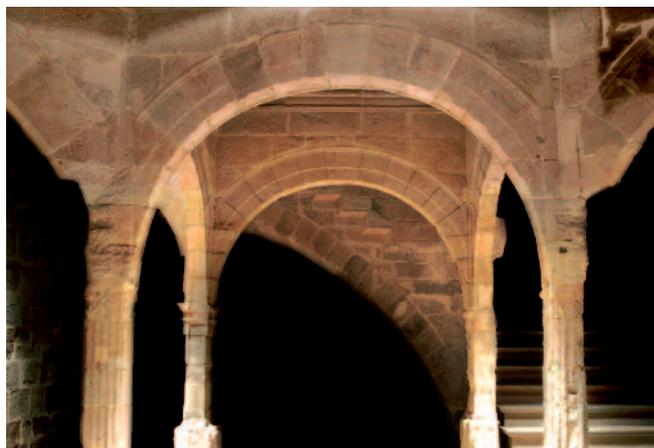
Cardona. Casa Rovira, estructura del claustro en planta baja una vez restaurado.
